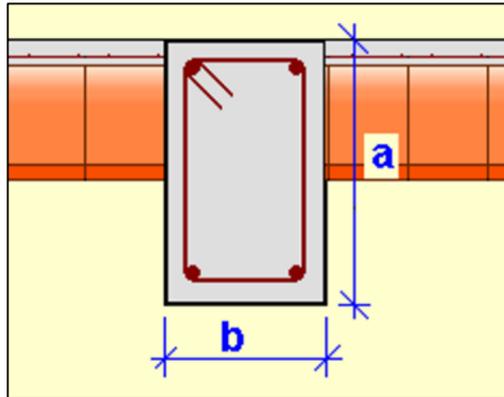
Sección tipo de viga descolgada rectangular. Fuente: CYPE
